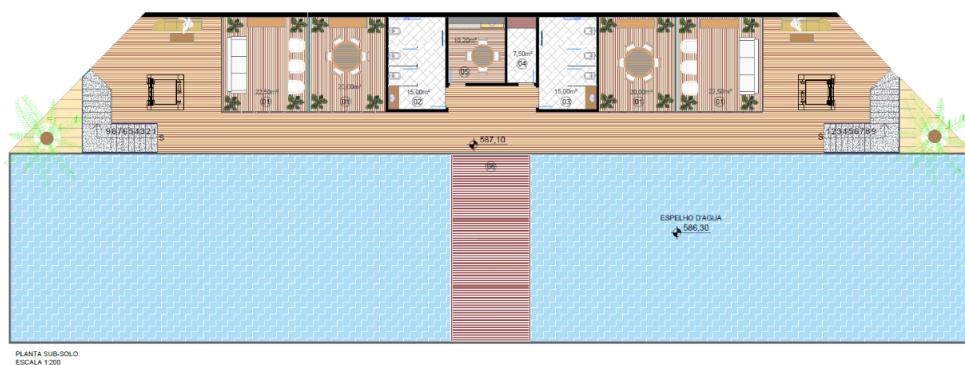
PLANTA BAIXA – SUBSOLO - Elaborado pelo autor.
